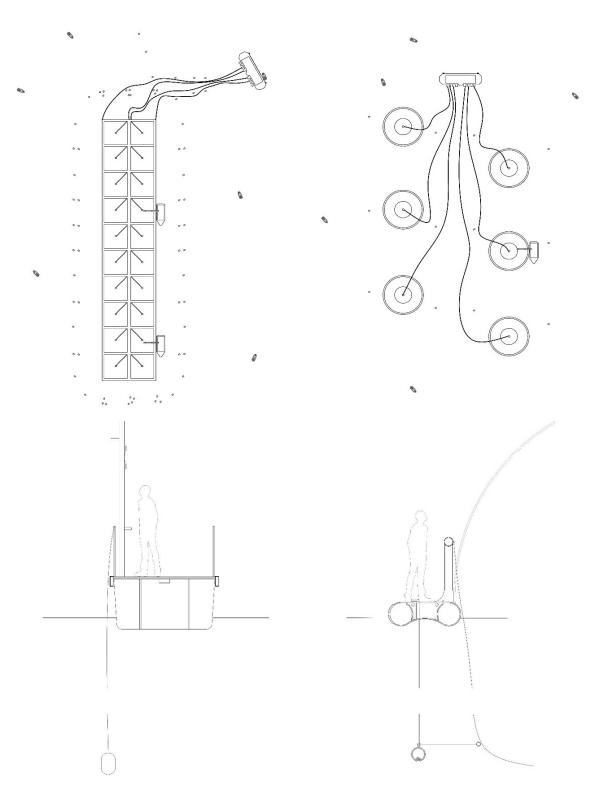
Escaneo de dibujos de levantamiento de jaulas de cultivo salmonero en planta y corte. Elaboración propia.
